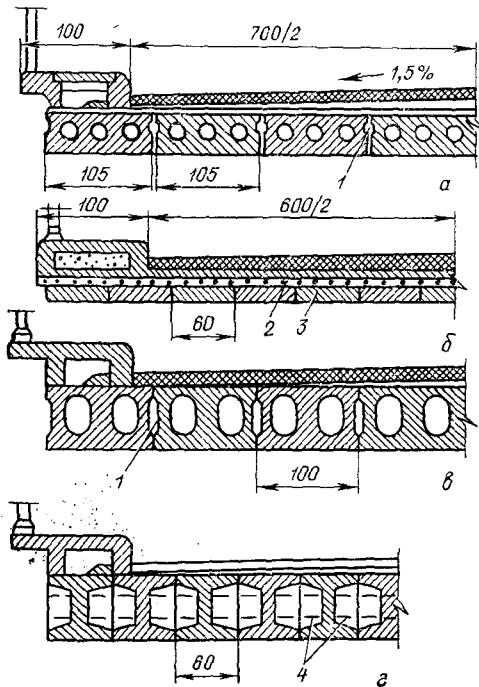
Поперечные сечения пролетных строений плитных мостов:
